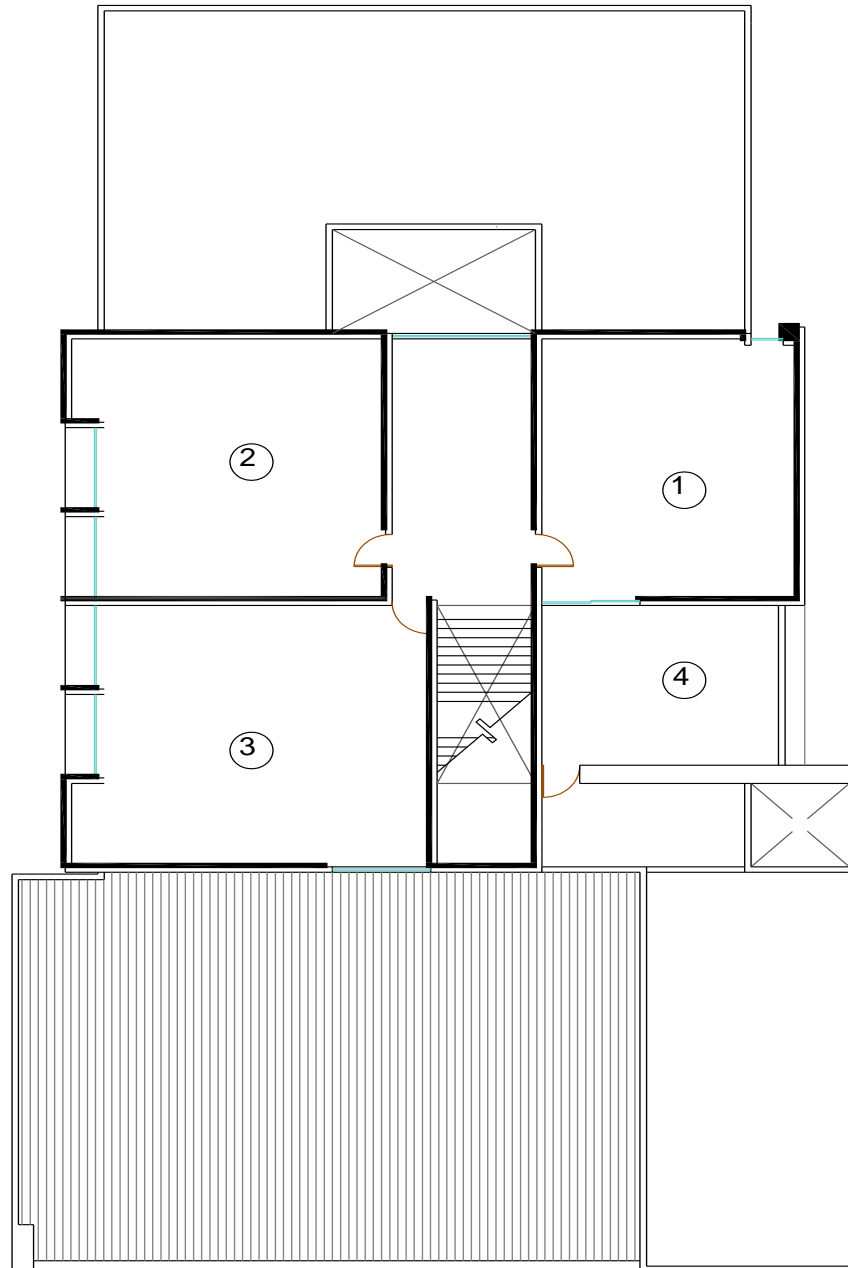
Planta alta del edificio de usos Múltiples.
